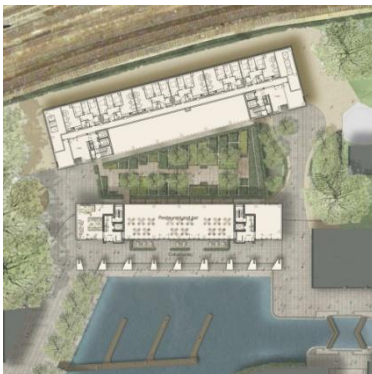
Planta do conjunto habitacional em Londres (2009), projecto dos Make Architects.
